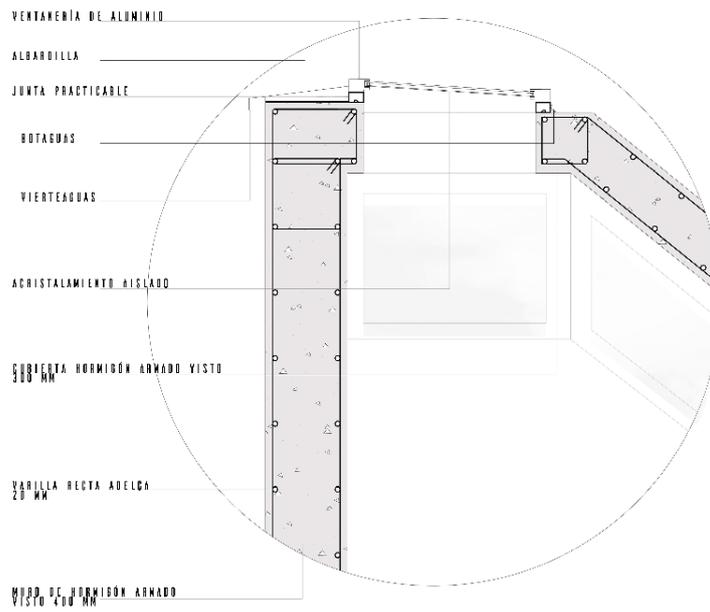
Detalle de Cubierta Archivo Histórico. Elaboración propia.
